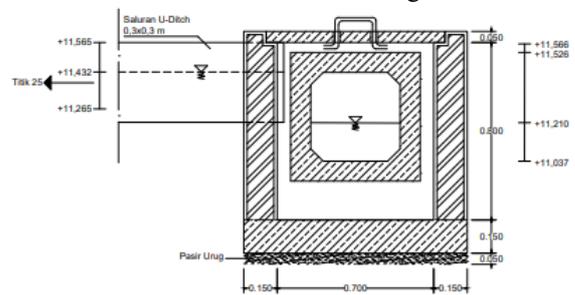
Tampak Depan Curb Inlet Saluran 29-30
